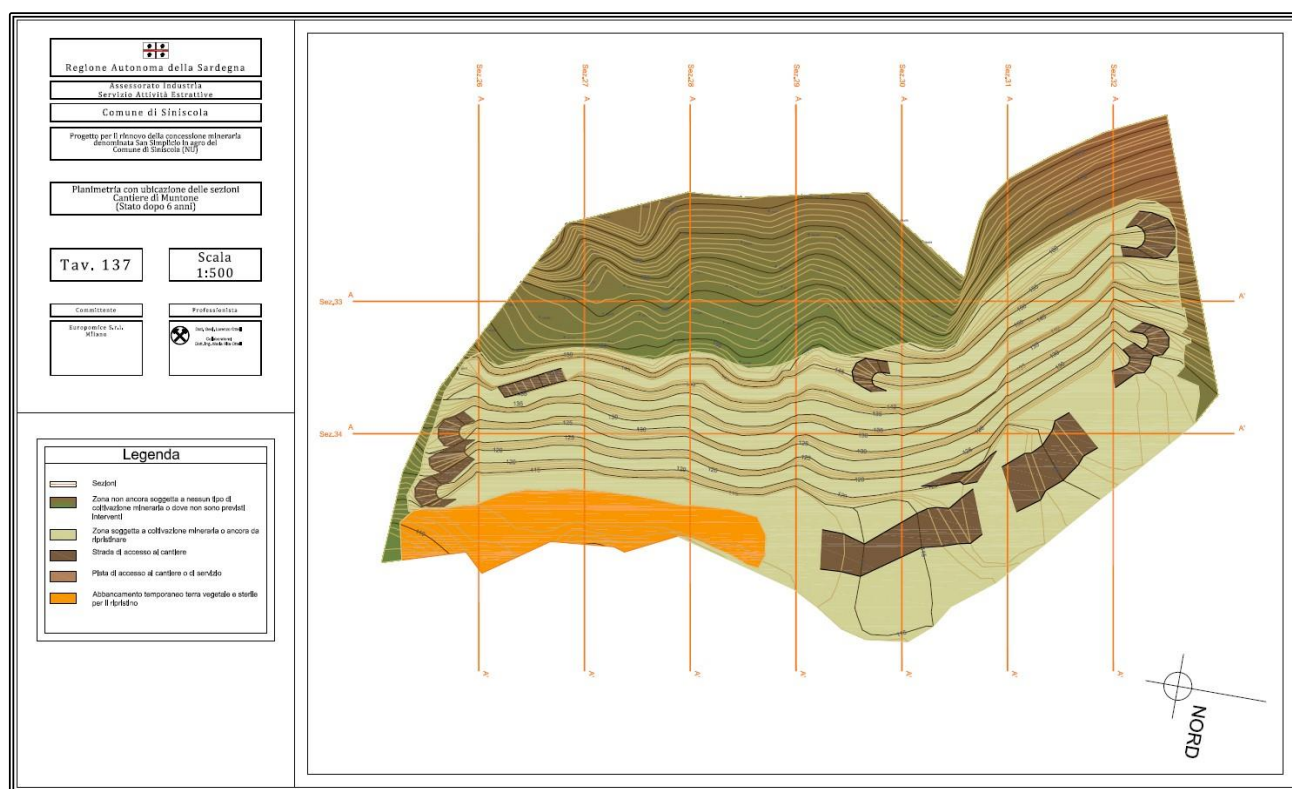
Planimetria dell'area del cantiere di Muntone così come nel periodo da tre a sei anni.
